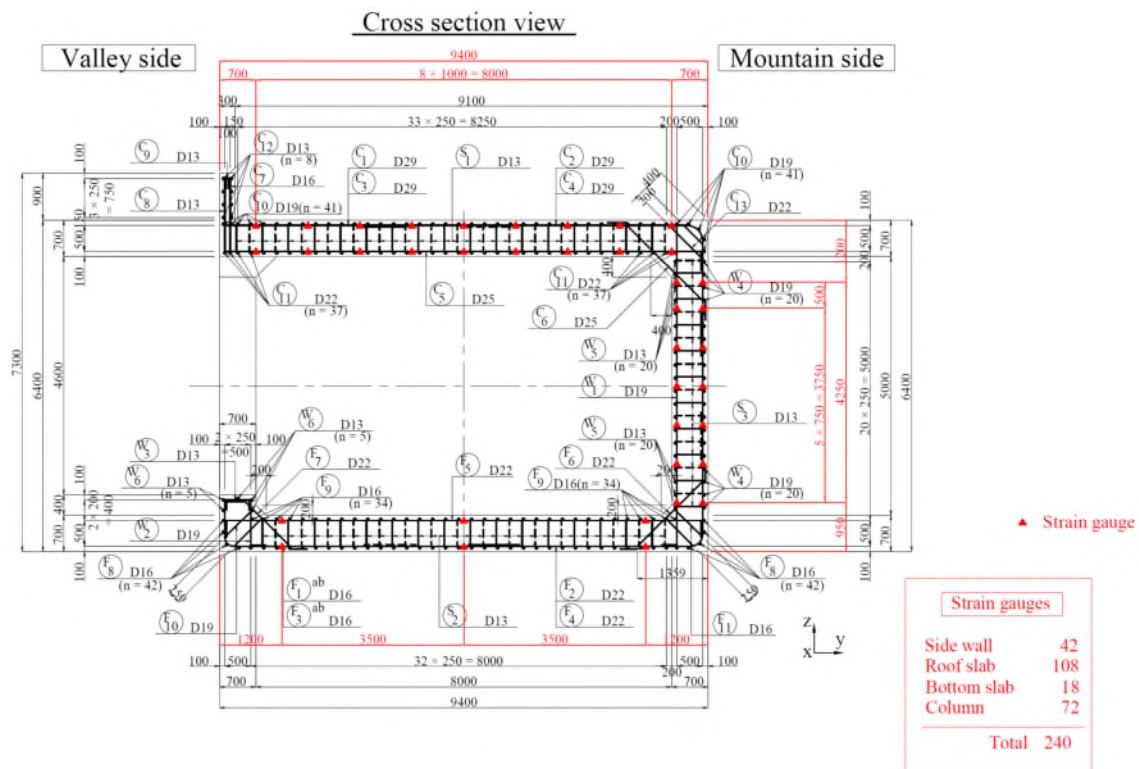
鉄筋ひずみゲージ設置箇所（断面図）
